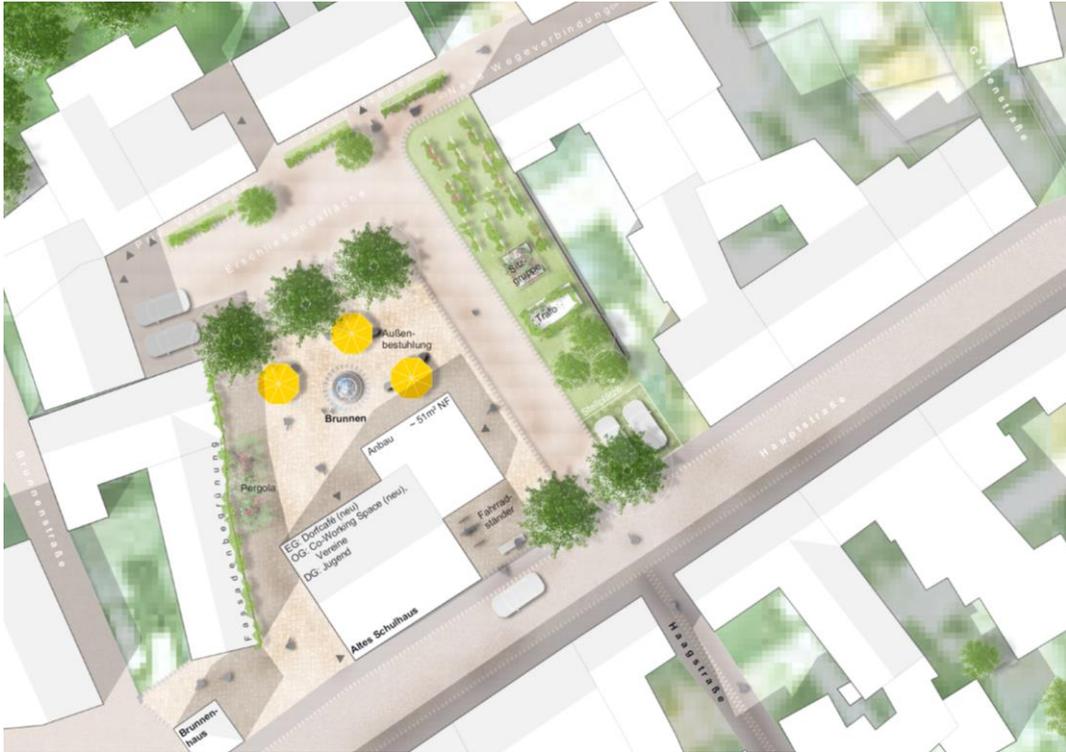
Lageplan Planung Dorfplatz (i.O. 1:200)
